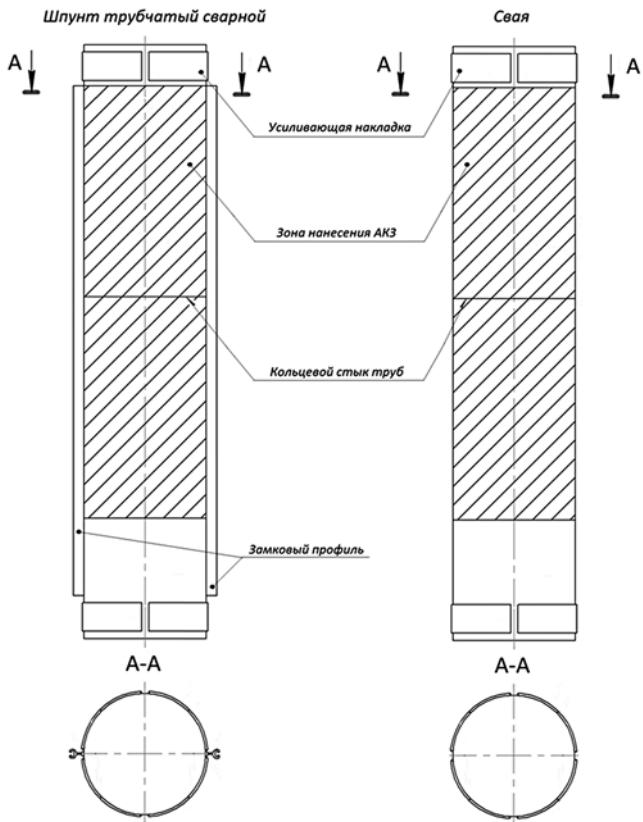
Общий вид шпунта трубчатого сварного и сваи
